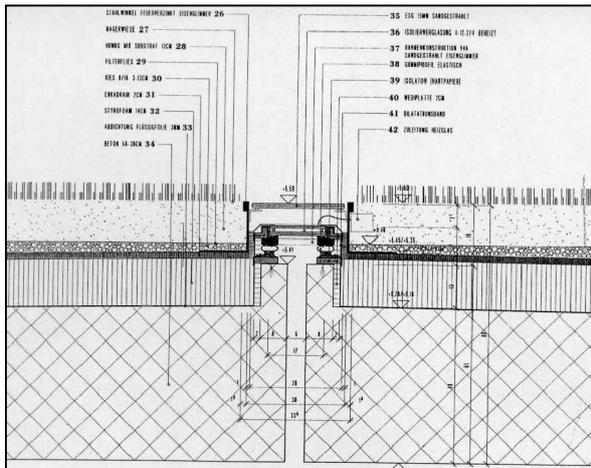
Detalle constructivo de los voladizos de las cubiertas que forman las juntas constructivas que se aprovechan para marcar líneas de luz natural en la losa al interior
